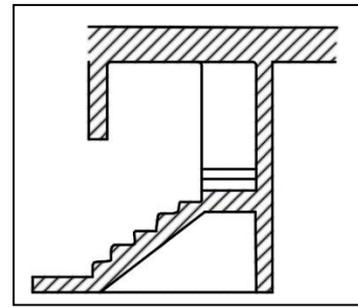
escaiers sur poutres de palmier. Source : fait par l'auteur
